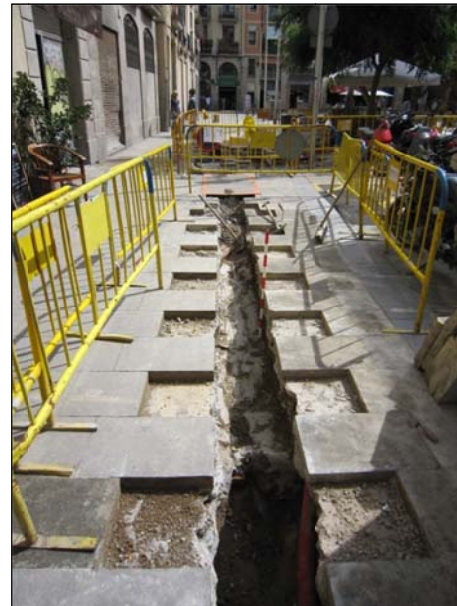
Vista de la rasa a l'inici del tram 3, a la Plaça de Jaume Sabartés.
